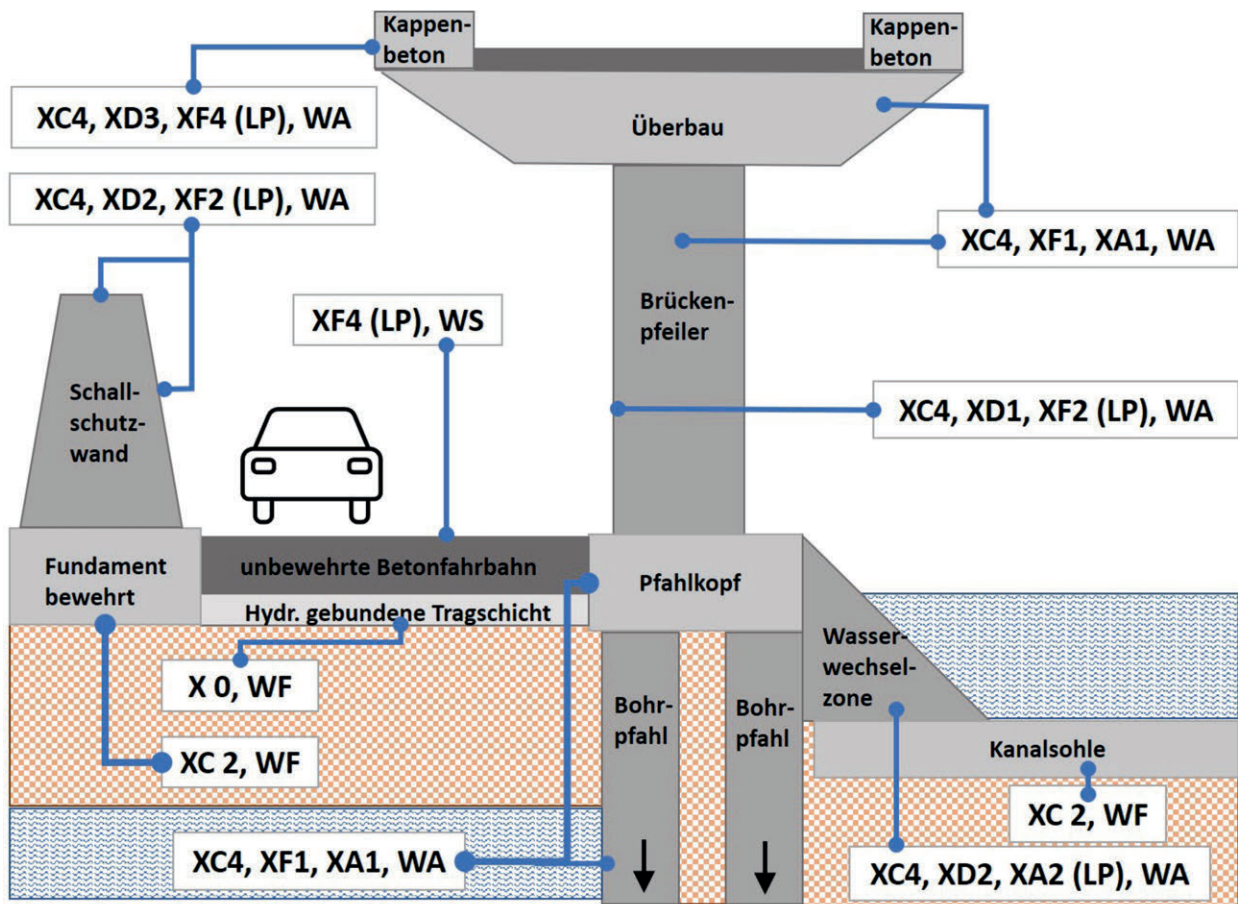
Expositionsklassen an einer Stahlbetonbrücke⁹
